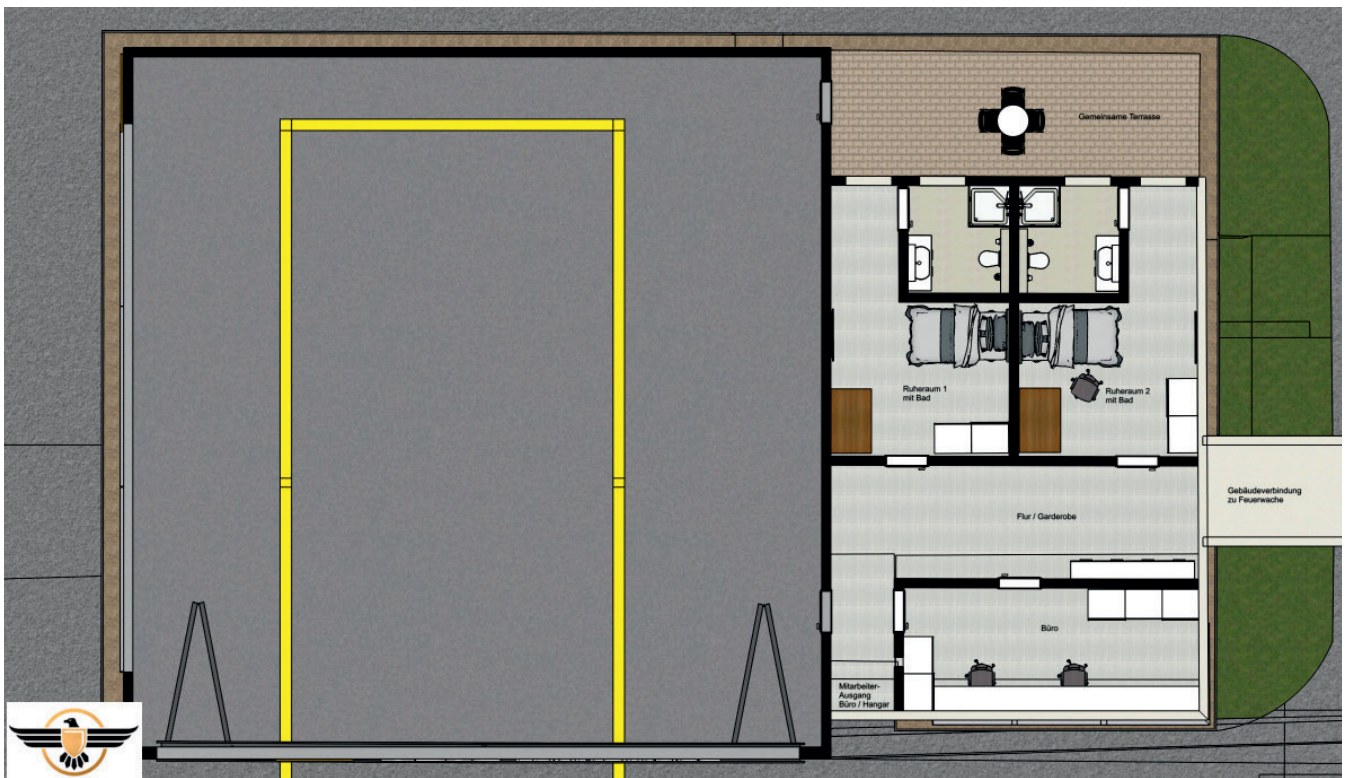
Beispiel einer Multikopterstation als Erweiterung bestehender Strukturen (Grundriss)
